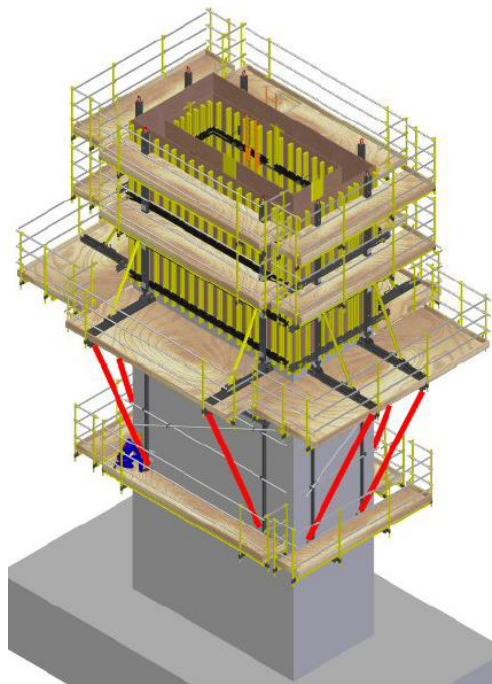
am. En rojo, los contravientos que van en los conos inferiores. Recuperado de: Ulma Construction, *Instrucción técnica de montaje*.
